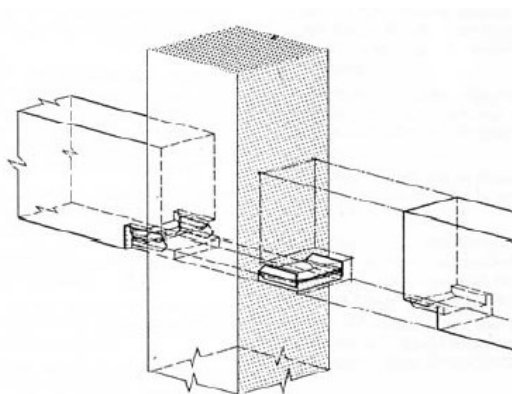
Modelo de ligação pilar-viga através de consola curta metálica (STUPRÉ, 1981).
